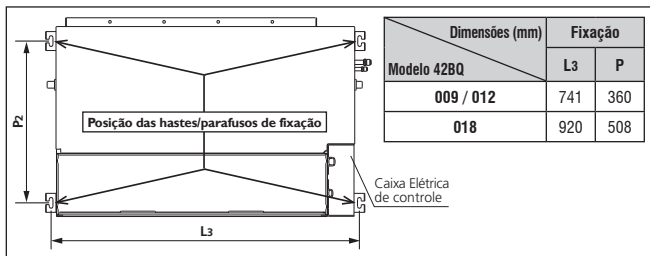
POSIÇÃO E DIMENSÕES DOS SUPORTES PARA FIXAÇÃO DA UNIDADE
